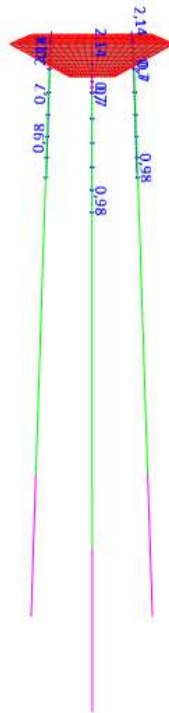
Beban Angin (WX) yang diterima Struktur *Catwalk 14
